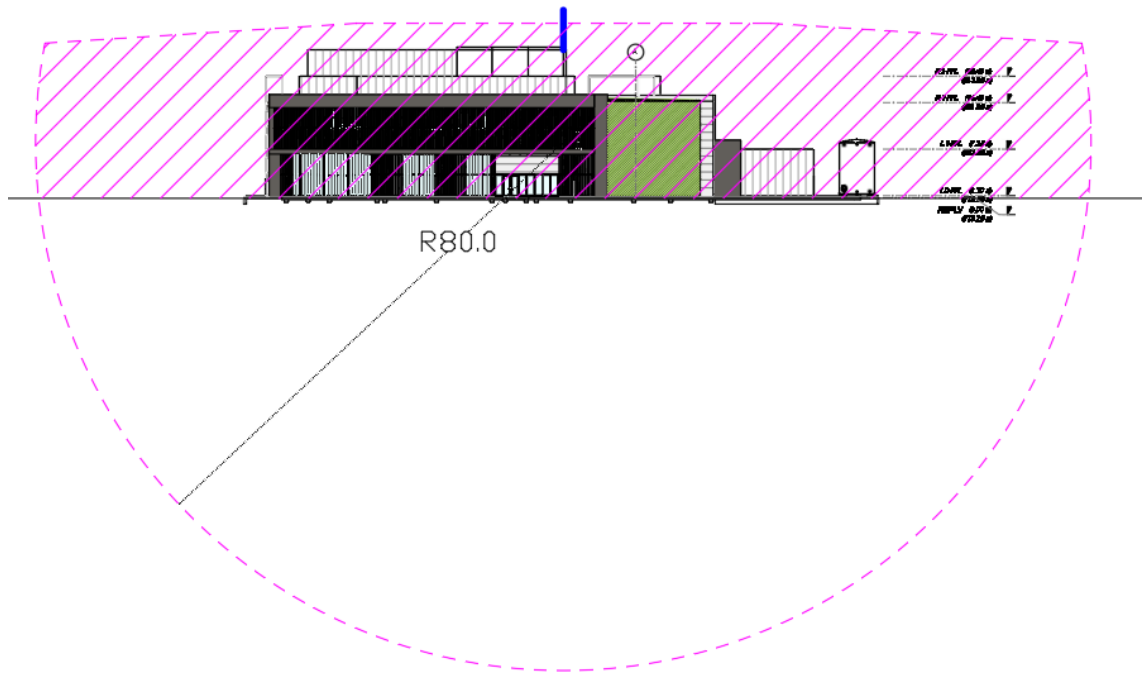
Ilustración 3: Volumen de protección PDC. Vista en perfil
